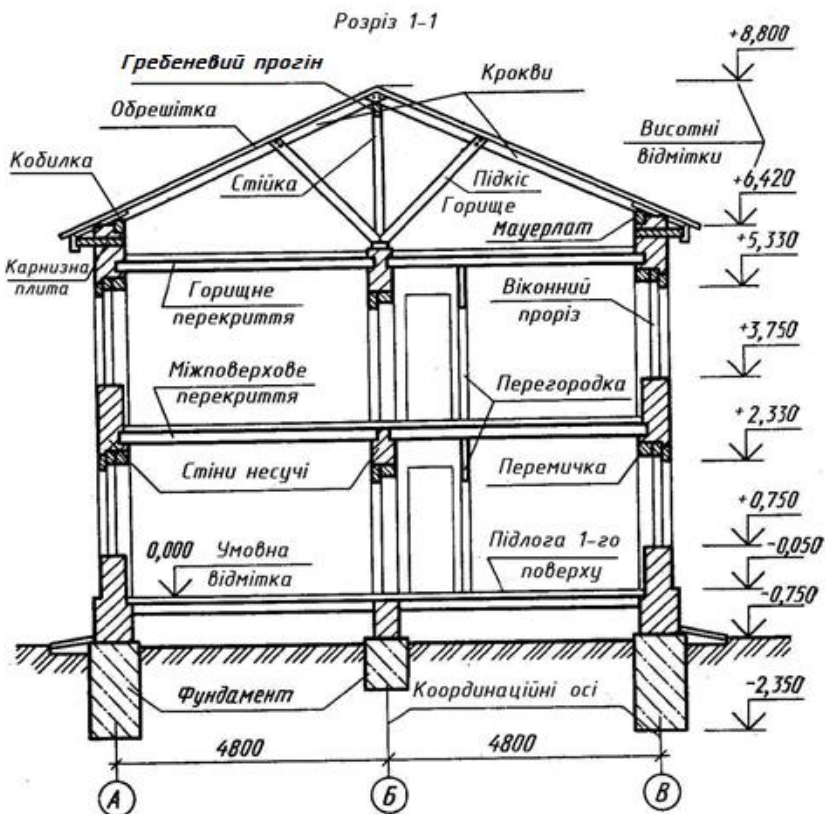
Основні конструктивні елементи будівлі з несучими стінами (розріз будівлі)
